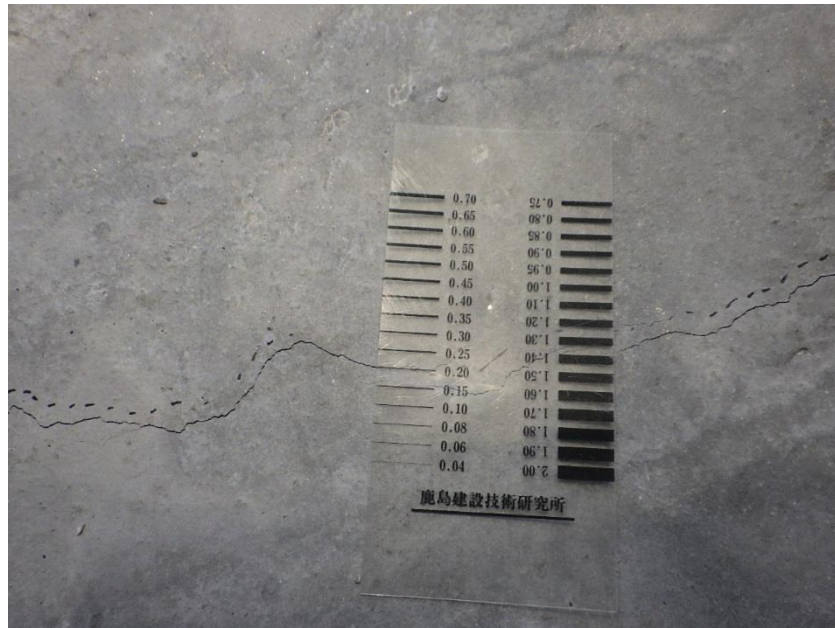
鉄筋コンクリート試験体ひび割れ発生状況 (②拡張後 2/2)
